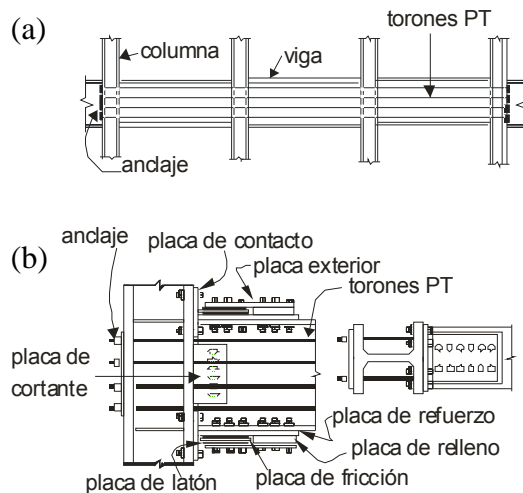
Elevación típica de (a) un piso de un PARM con CPEF y (b) detalles de conexión.
